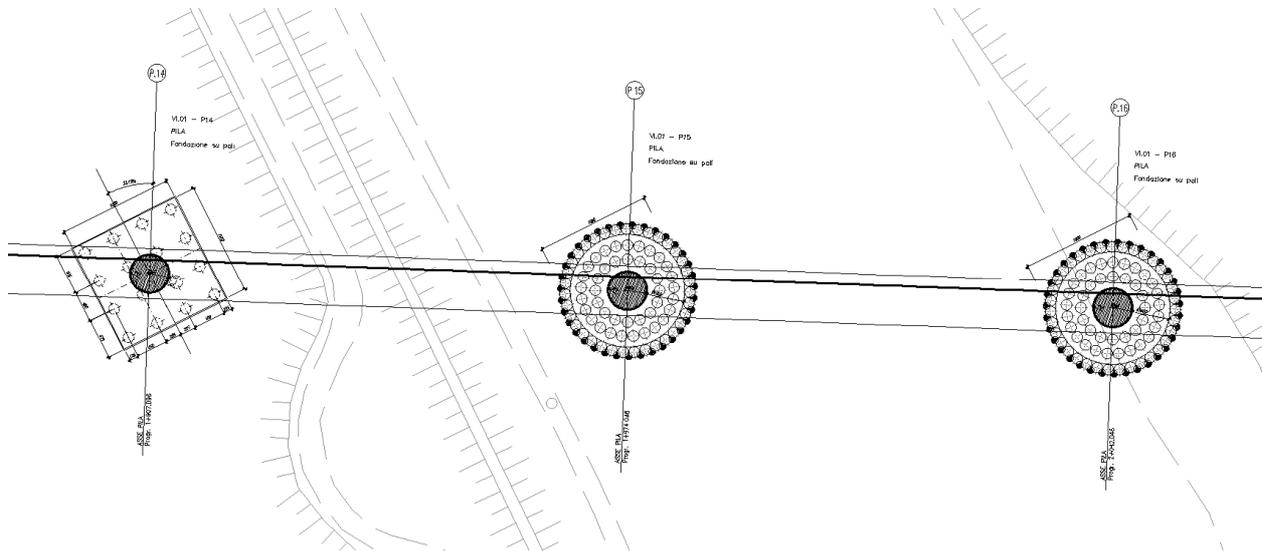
Pianta fondazioni – Campate a struttura reticolare in acciaio a via inferiore a doppio binario
